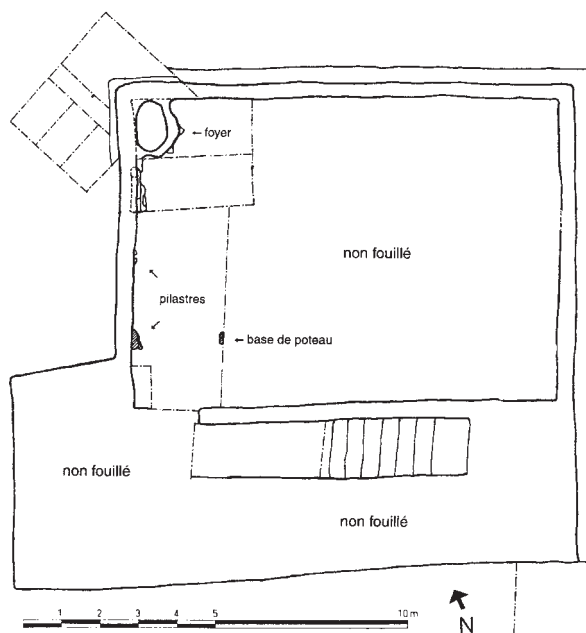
Bâtiment G, plan à l'État 2. Noter les traces de pilastres muraux et une des bases de poteau.
